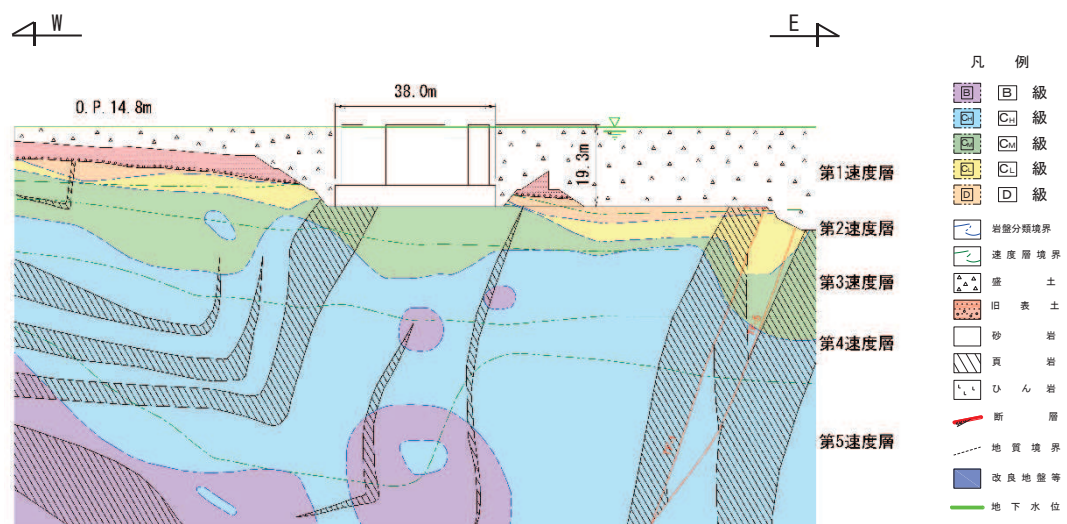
(2) 排気筒基礎 地震時荷重算出用地質断面図 (EW 断面)
